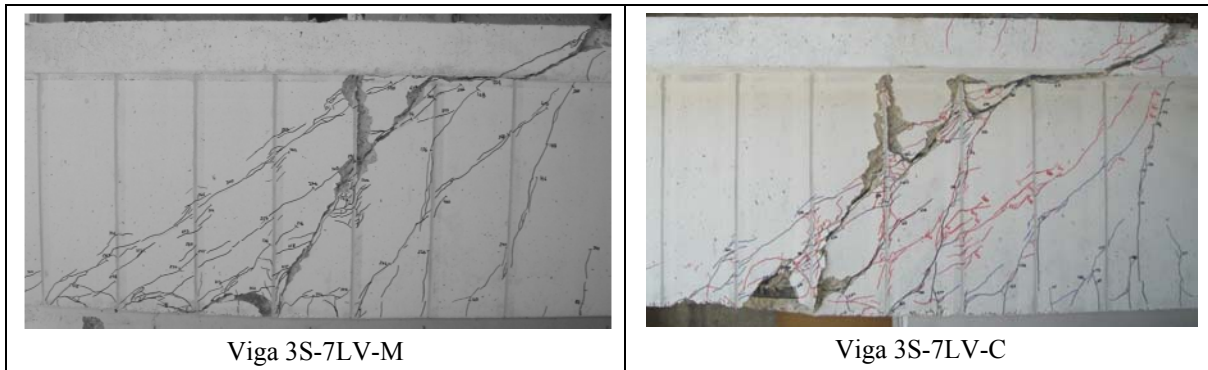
Comparação da fenda de rotura de corte das vigas 3S-7LV-M e 3S-7LV-C.
